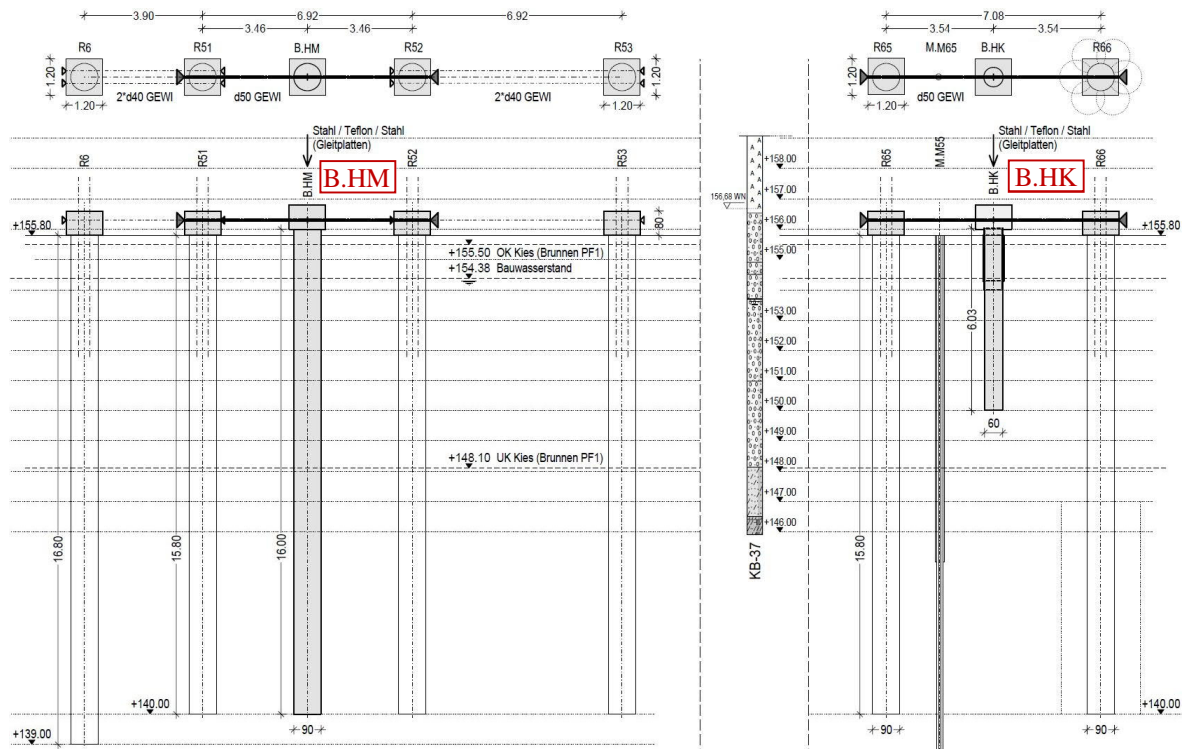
Baugrundsituation & Prinzip der Versuchsanordnung, Planausschnitt aus [84]
